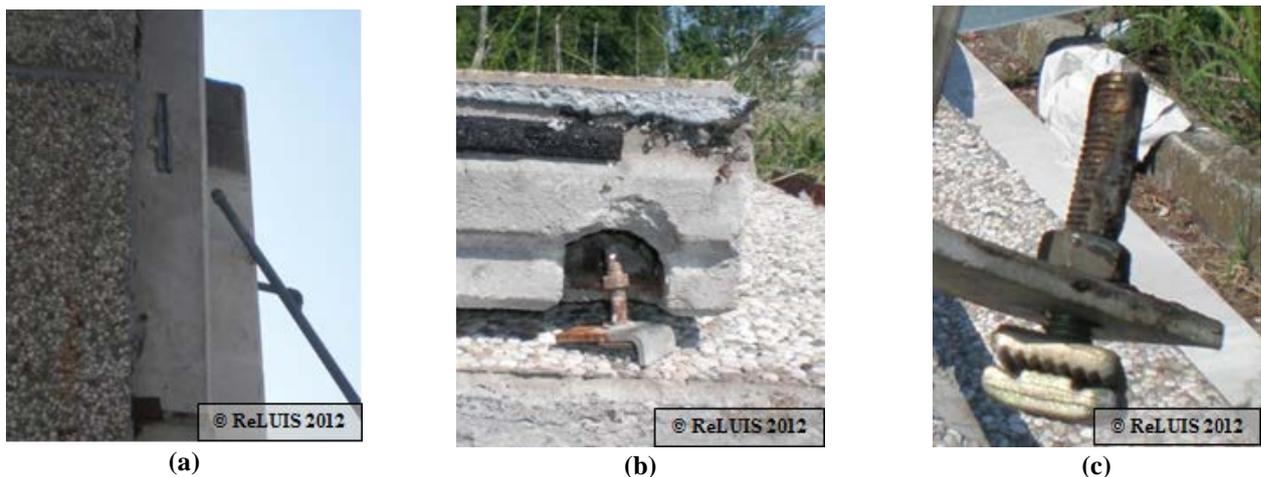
Crisi della connessione di un pannello di tamponatura orizzontale nella sua parte superiore: (a) dettaglio dell'ancoraggio superiore realizzato tramite profilo a C in acciaio annegato nel pilastro che ha subito il fenomeno dello slabbramento, (b) squadretta di collegamento e (c) connettore con testa a martello
